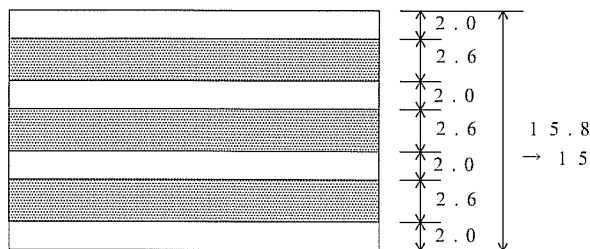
コンクリート型枠用合板の単板構成 (単位: mm)
